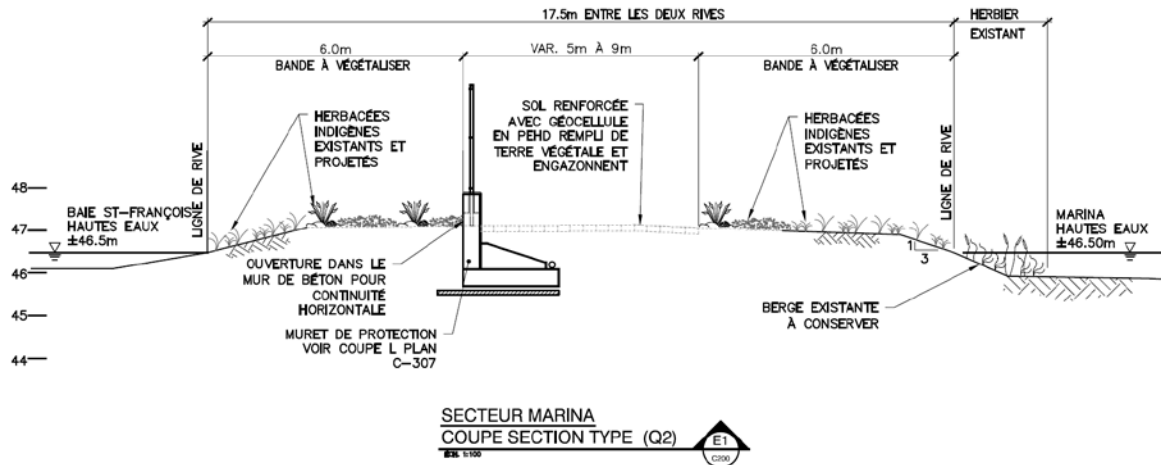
Coupe-type E1 – Langue de terre et muret de protection
